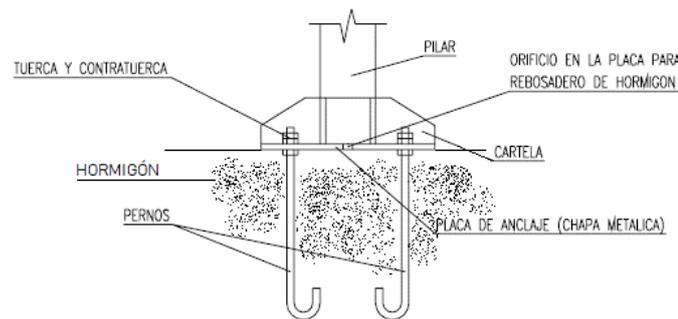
Unión entre pilar y columna. Fuente: Brotóns (2010)
